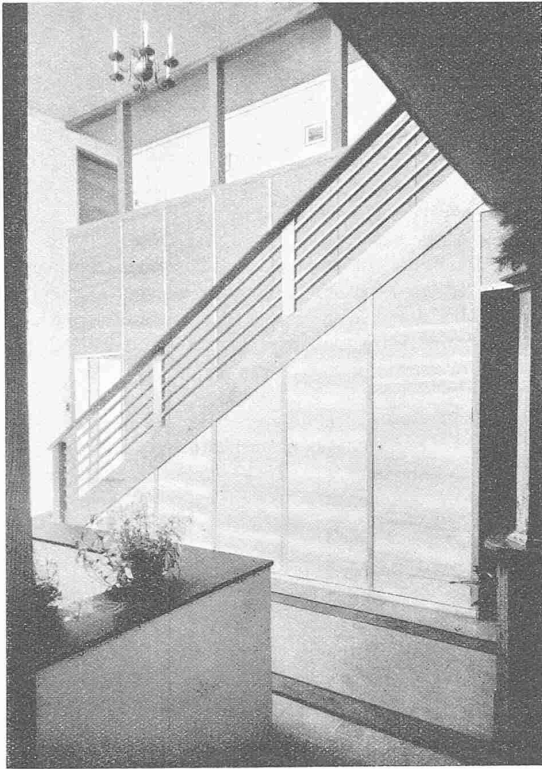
Haus „Am Rank“. Halle mit Treppe zum Dachgeschoss.
